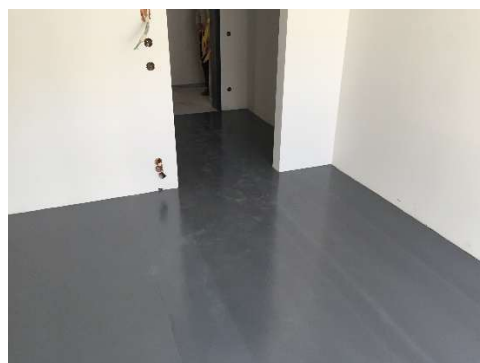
Couche intermédiaire stabilisante posée de manière flottante sur le SensFloor
